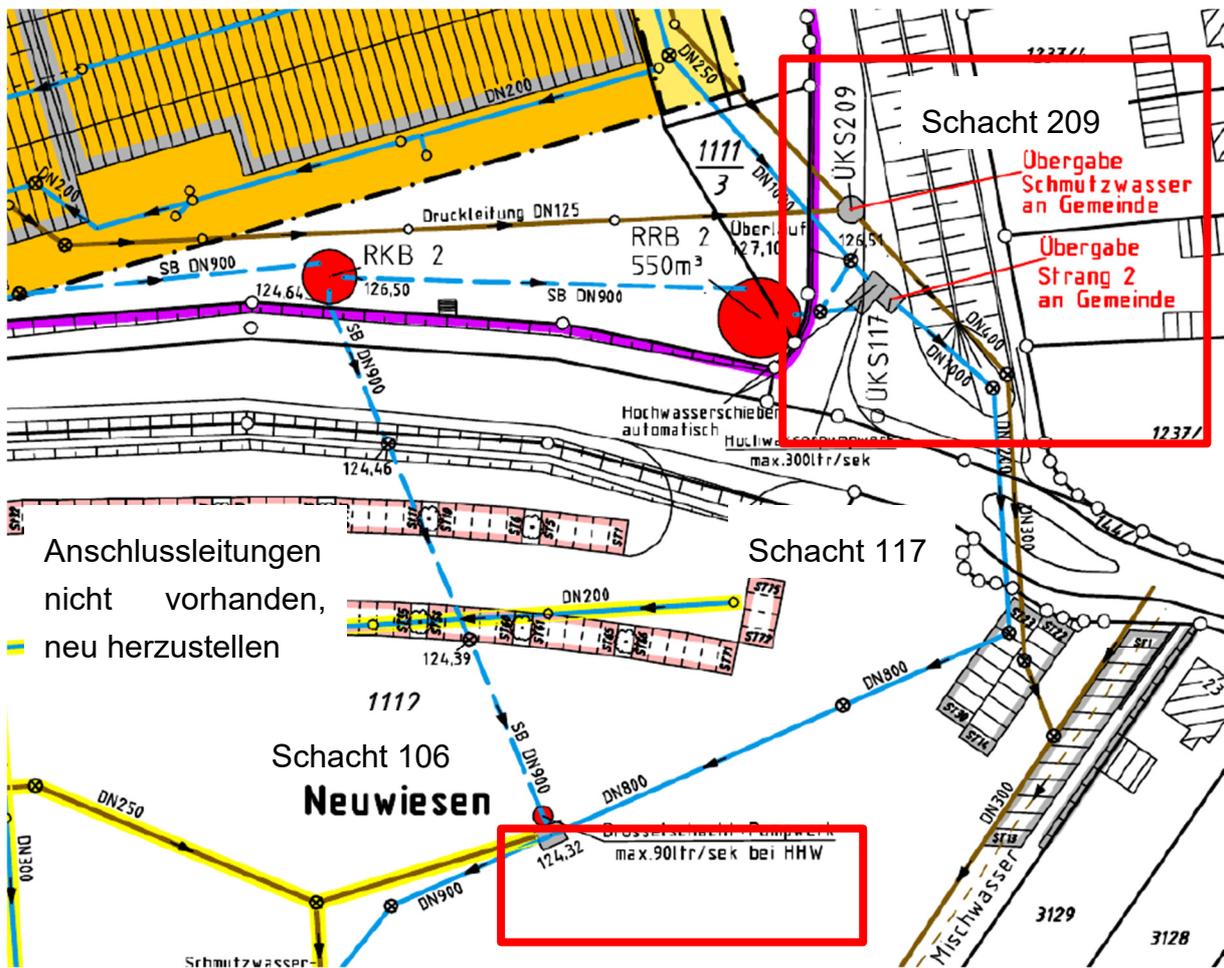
Anschlusspunkte Spanplattenwerk [Auszug Lageplan Vermessungsbüro Klein, 01.12.2005]
